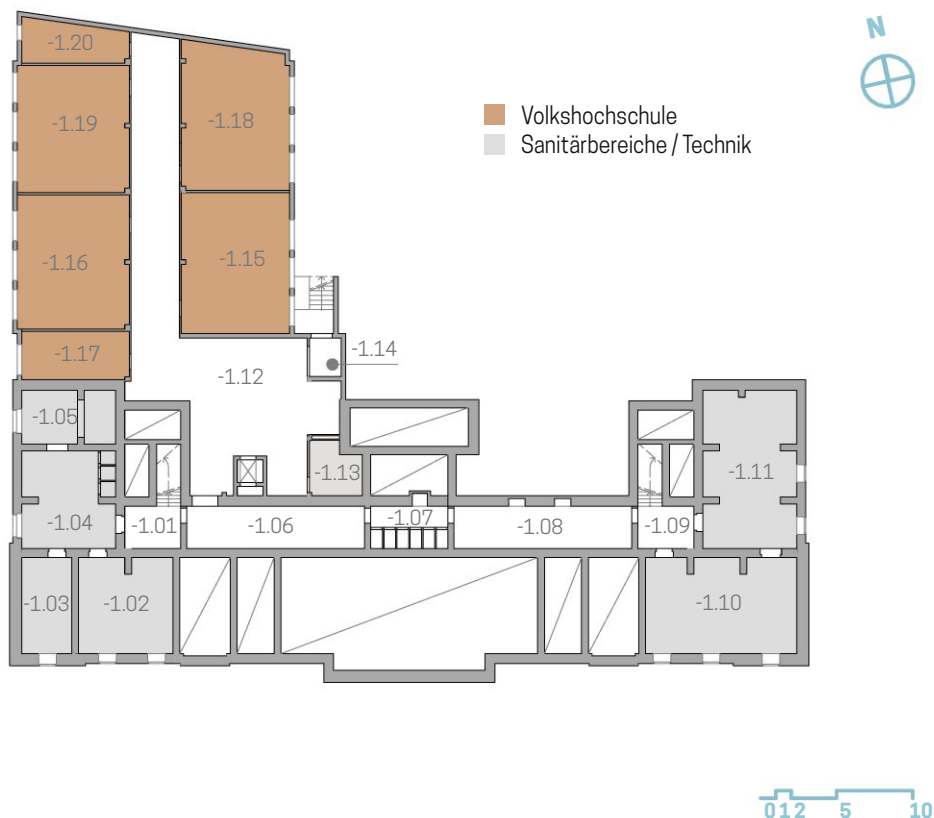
Bestandsaufnahme: Grundriss Kellergeschoß.
